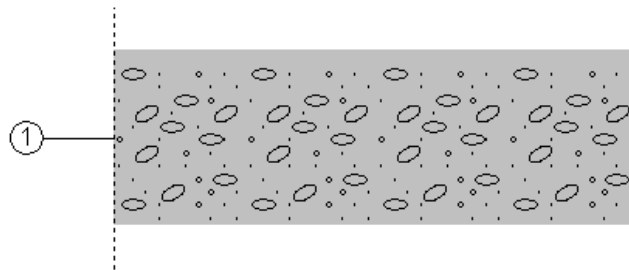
Detalle constructivo de los componentes del suelo en contacto con el terreno del garaje.
